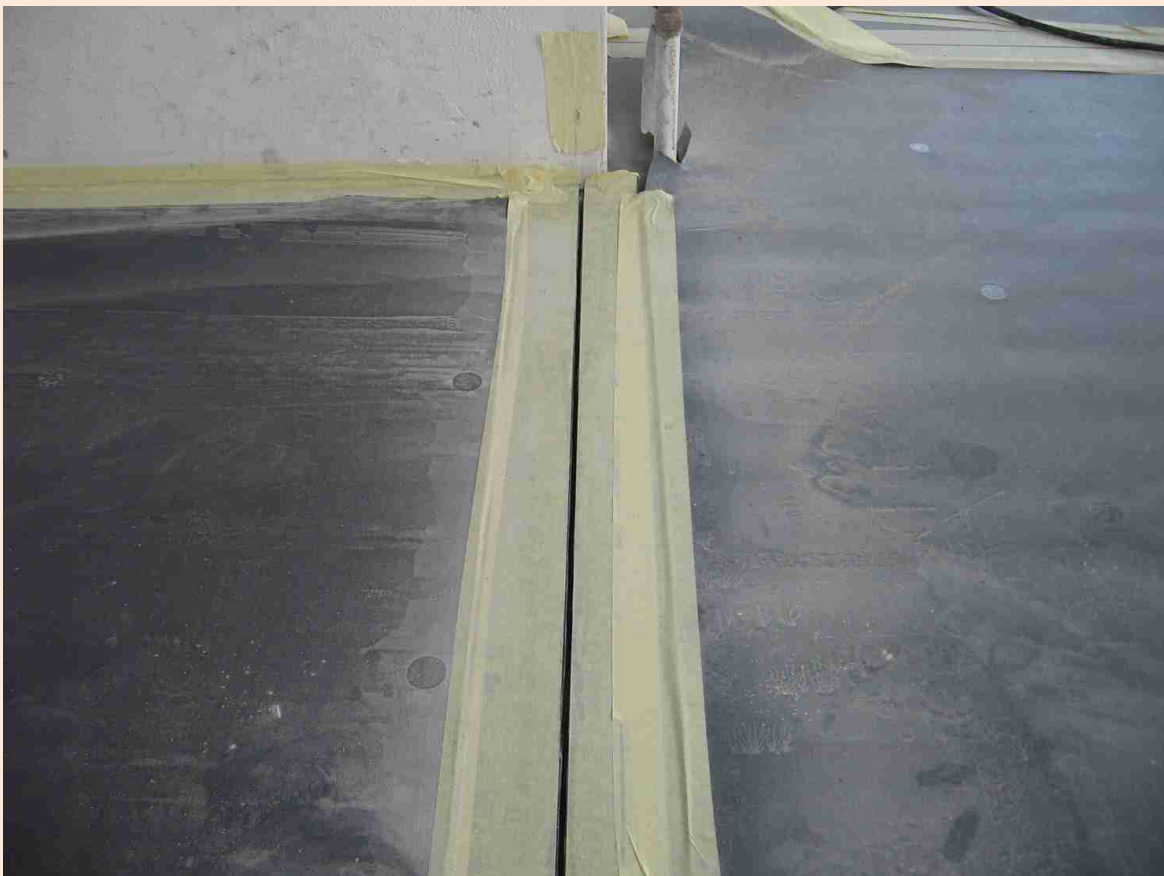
mit gerader Schnittführung fertiggestellte Fugenkammer
